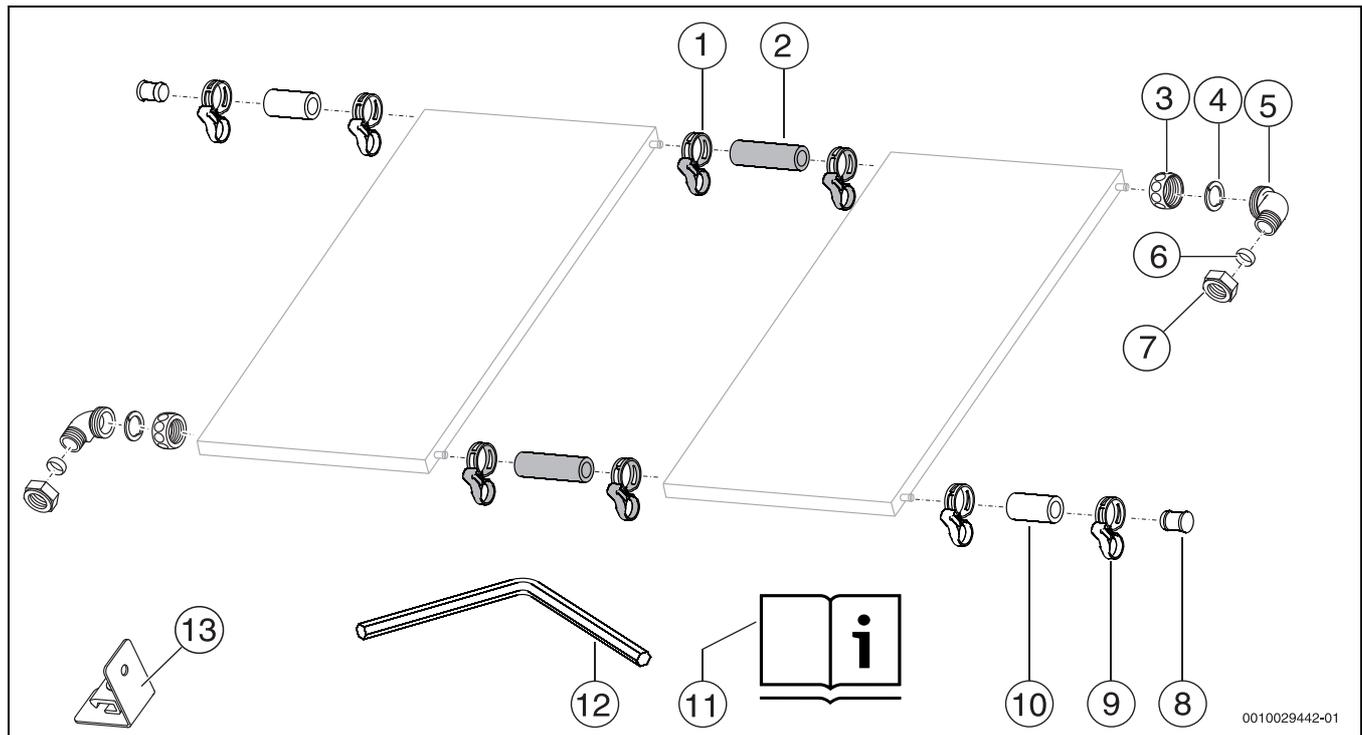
1 Anschluss-Set Flachdach und 2 Verbindungs-Sets (grau)
